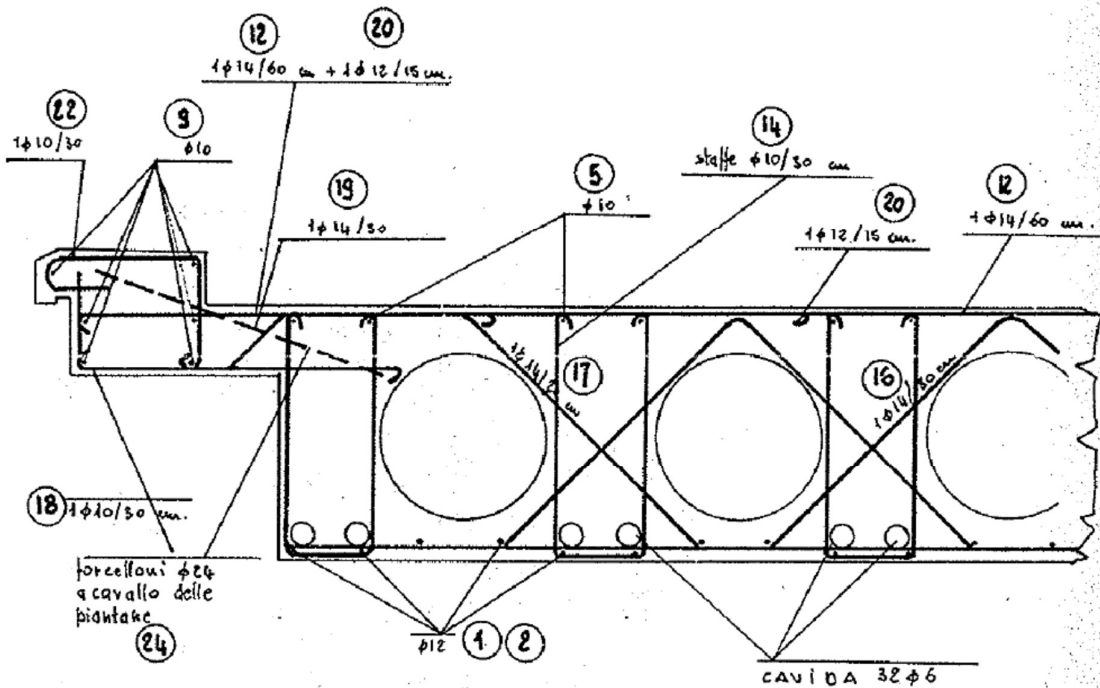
Sezione trasversale della soletta con armature (Tavole di progetto opera originale)
